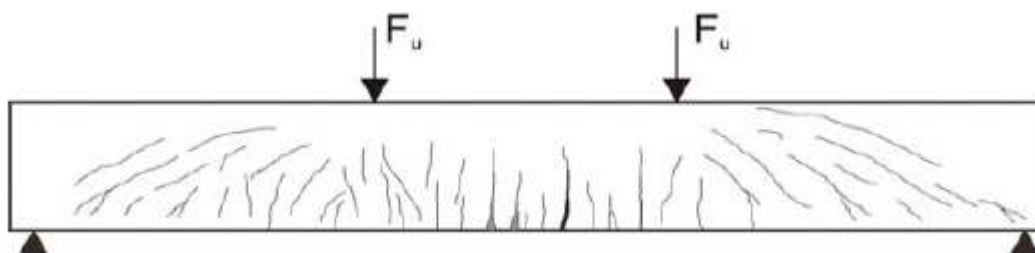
Esquema da configuração de fissuração da viga na ruptura
